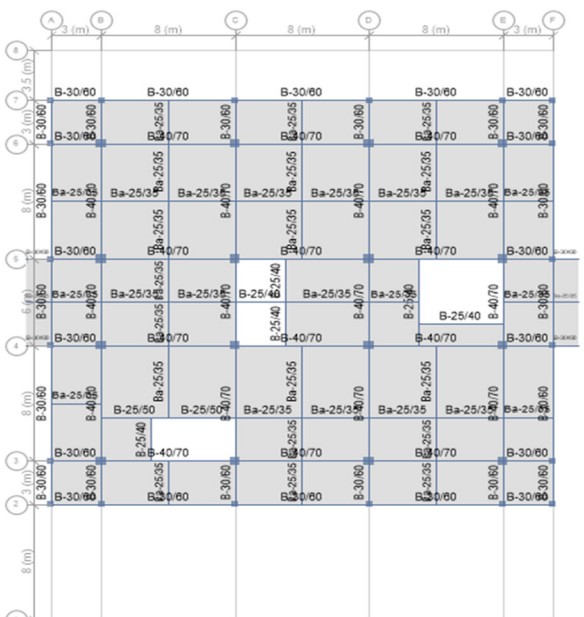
Denah Lantai 4, lantai 5 dan Lantai 6
